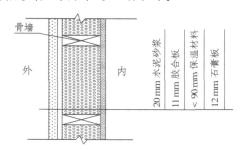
落叶松胶合板复合墙体构造示意图 Fig 1 The structural pattern of the wall composed of larch plywood
